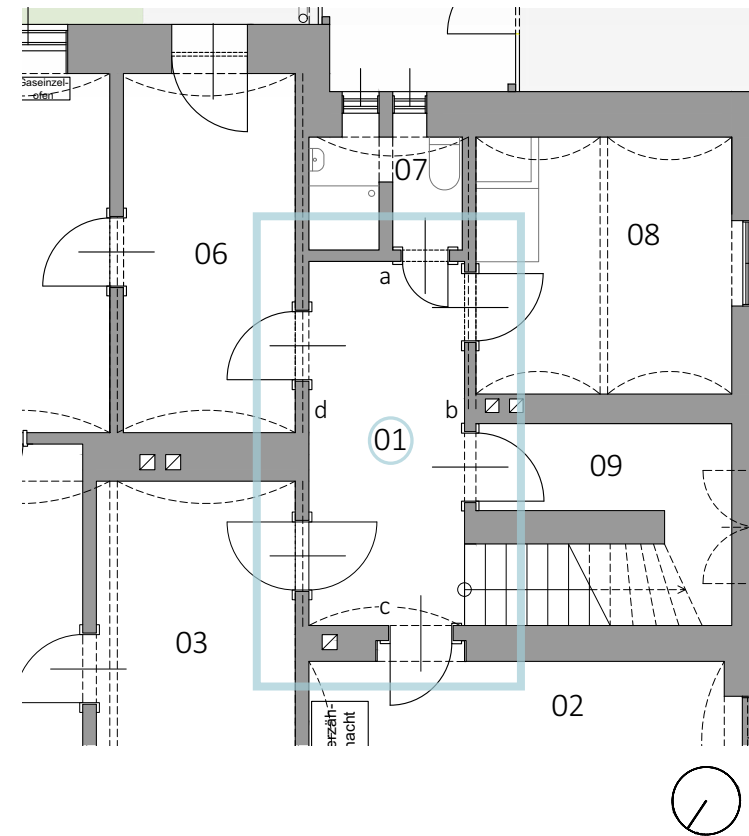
Grundriss UG 01 Vorraum, M=1:100.
